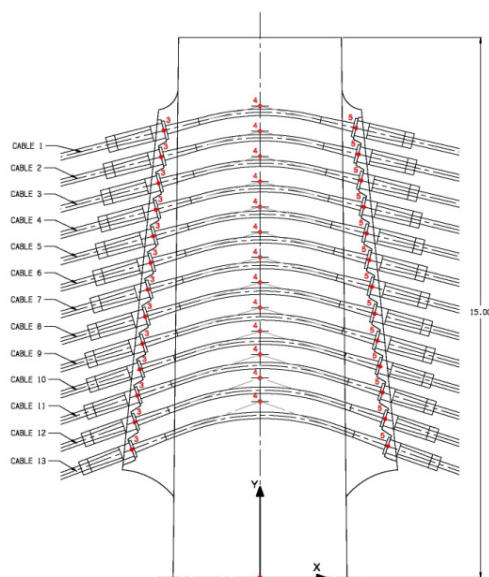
Definición de las sillas de los pilonos para los tirantes extradados
